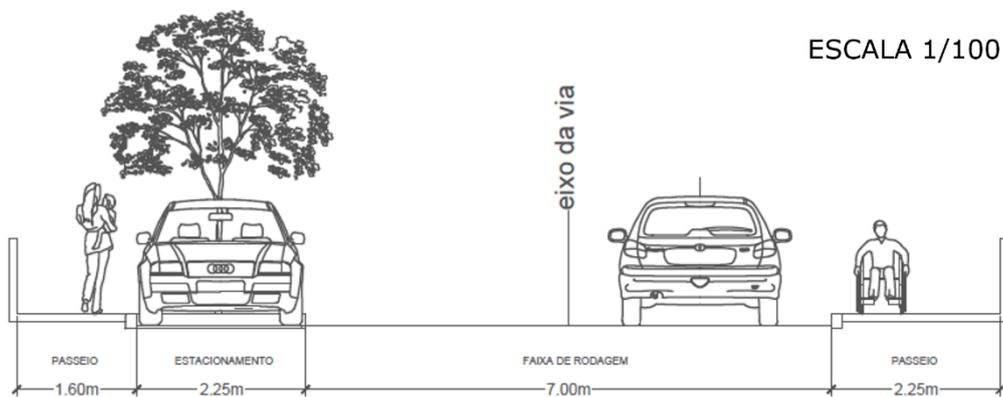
Perfil proposto para a Rua Joaquim Aleixo (zona norte) – Perfil A
